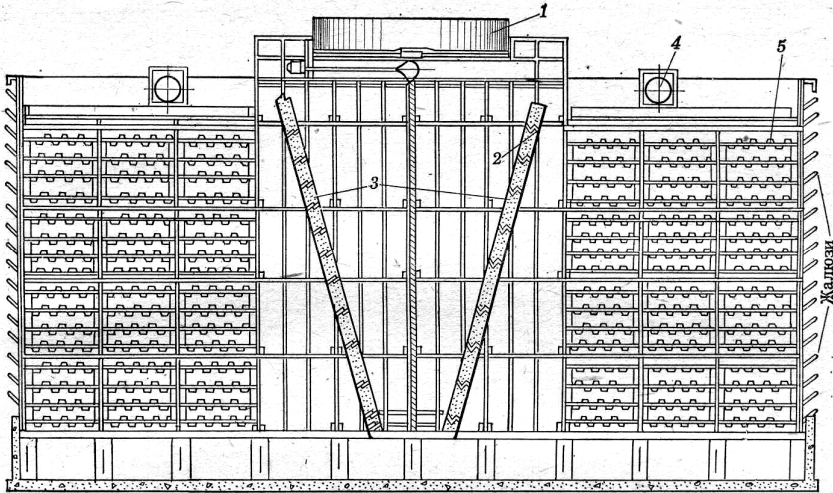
Схема крапельної градирні з витяжною вентиляцією:
